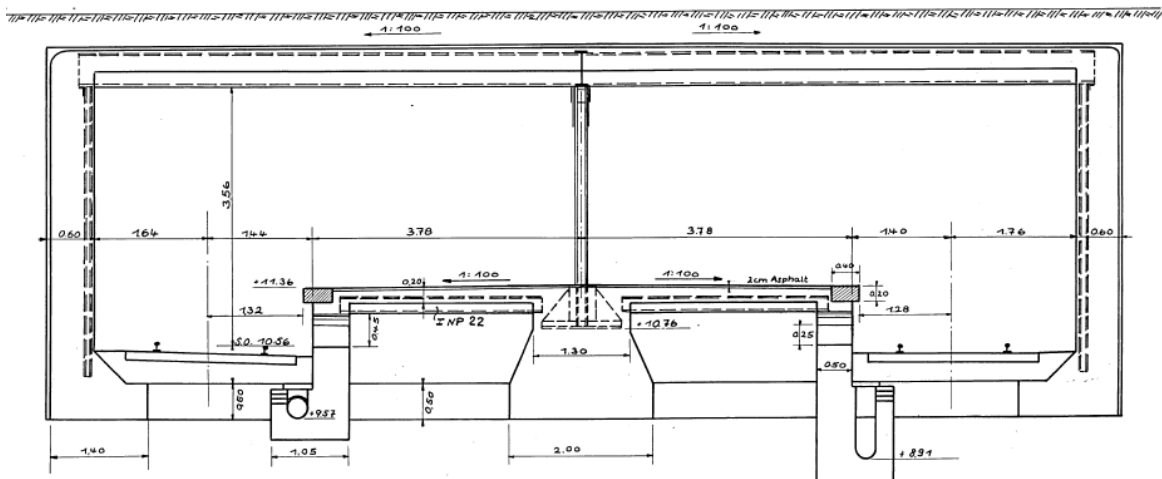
U-Bahn-Station Sternschanze, Bestandsplan [U26]
